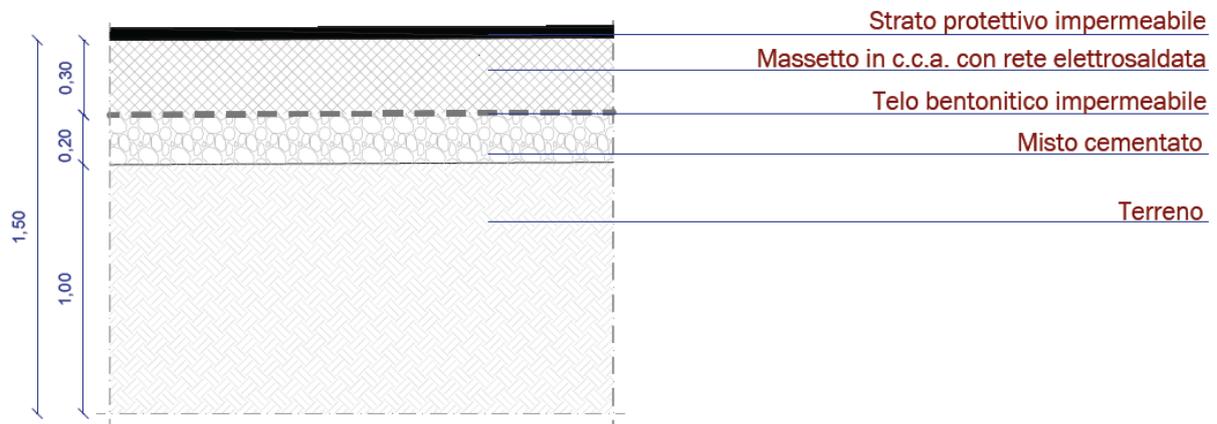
Dettaglio pavimentazione superfici esterne al piazzale.
